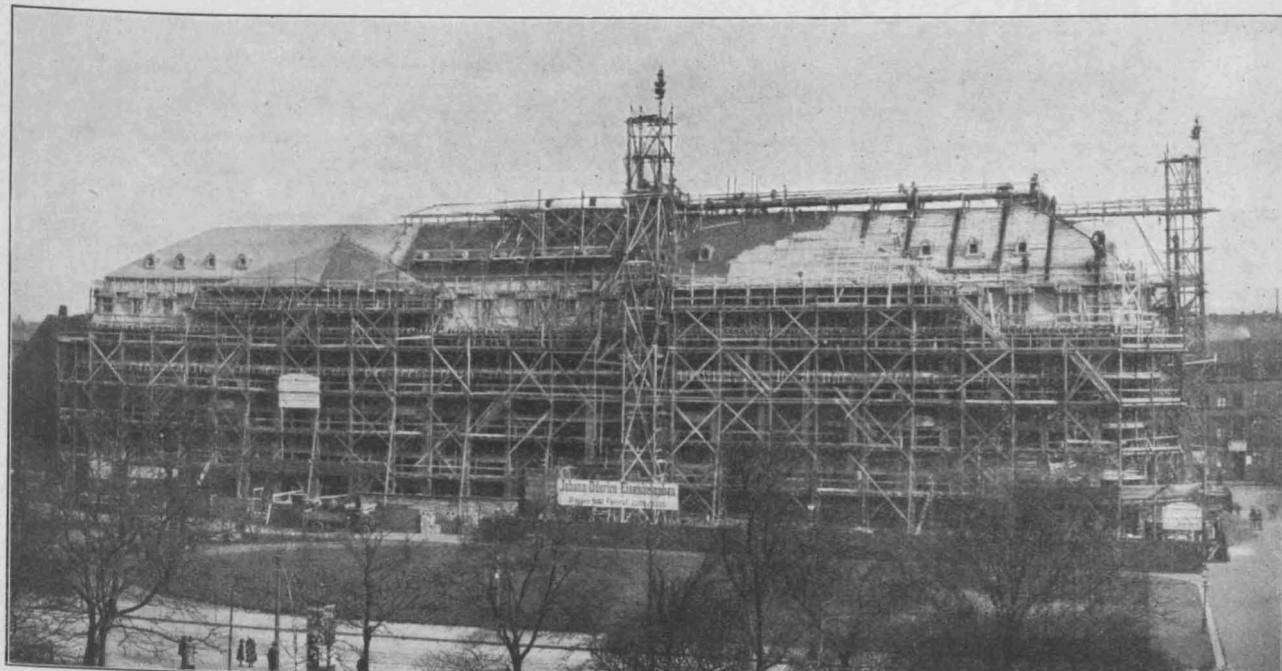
Gesamtbild des Baues mit Beton-Aufzügen während Betonierung des Daches.
